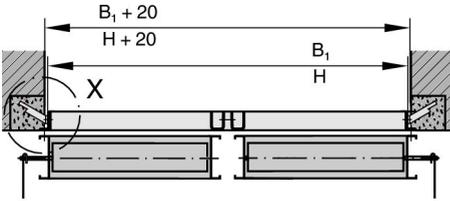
Wandanbau mit Einbaurahmen Breitengeteilt (Stahl-/Edelstahl-Ausführung)
